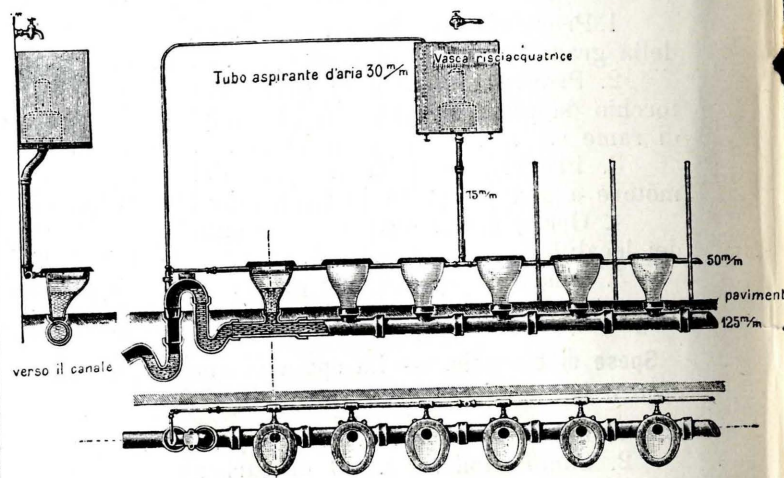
Fig. A. — Sezione, prospetto e pianta del cesso Wolfsholz.
